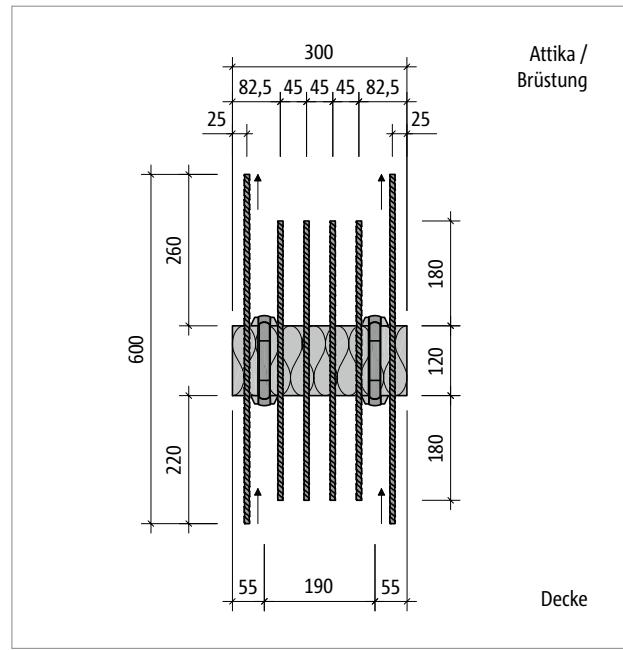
Schöck Isokorb® CXT Typ AP-MM1-REI30-LR240: Produktansicht für Deckendicke D = 220 mm - Eckstäbe sind um -20 mm verschoben.
